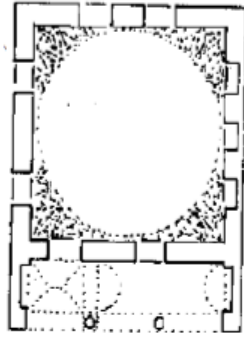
مسقط أفقي لمسجد طاش في قونية
